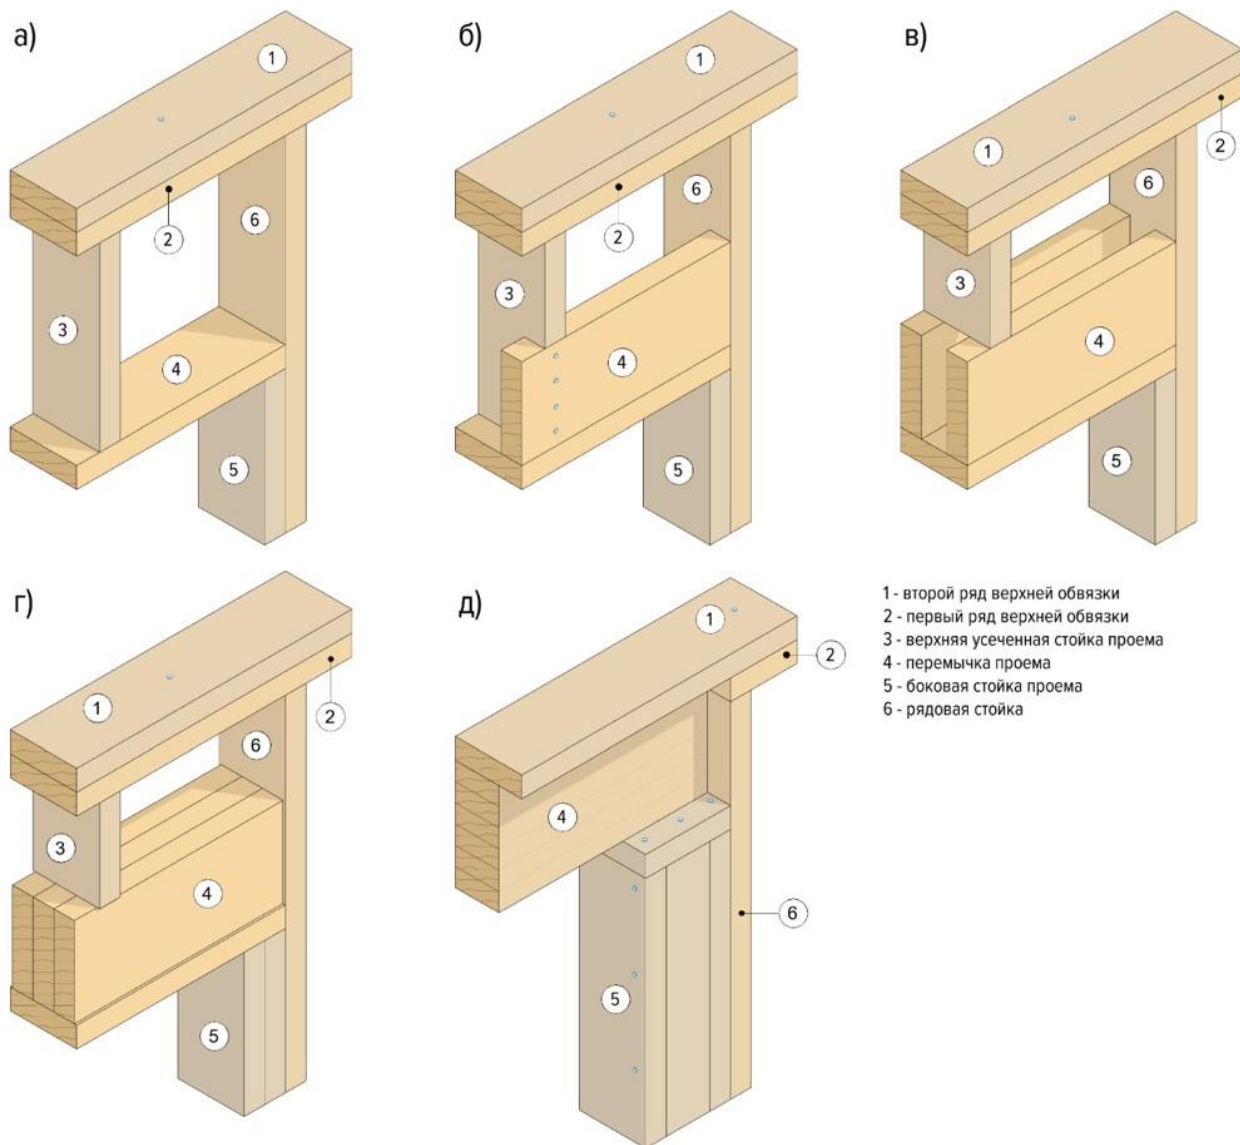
Схемы перемычек над проёмами несущих стен
